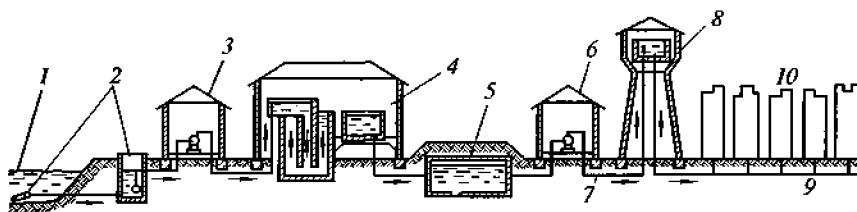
Схема водопровода с забором воды из открытого водоема:
